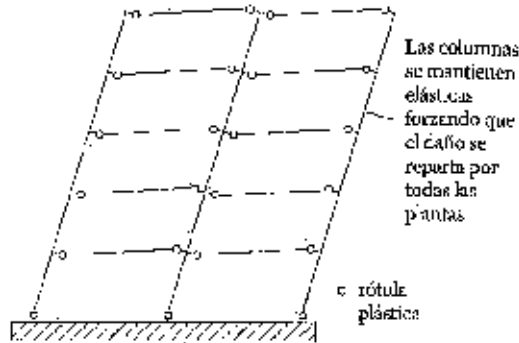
Estructura del tipo pilar fuerte-viga débil. (Fuente: Benavent-Climent, 2010)
